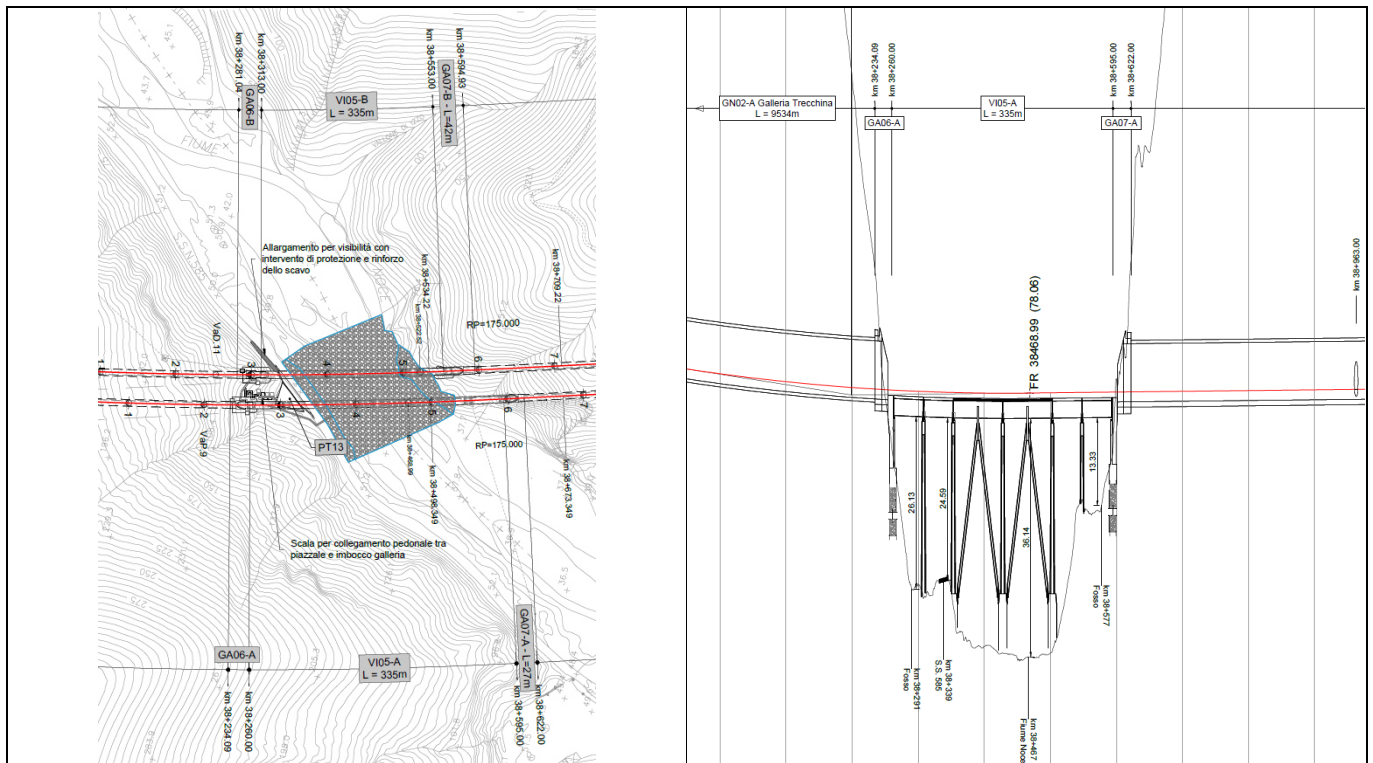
Planimetria e profilo di progetto VI05 da km 38+260 al km 38+595 BP
